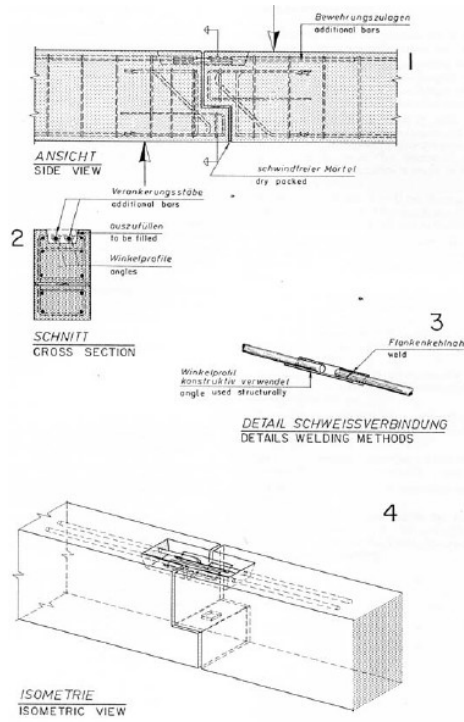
Ligação por juntas em dente e barras de aço superiores soldadas (Stupré, 1981)
